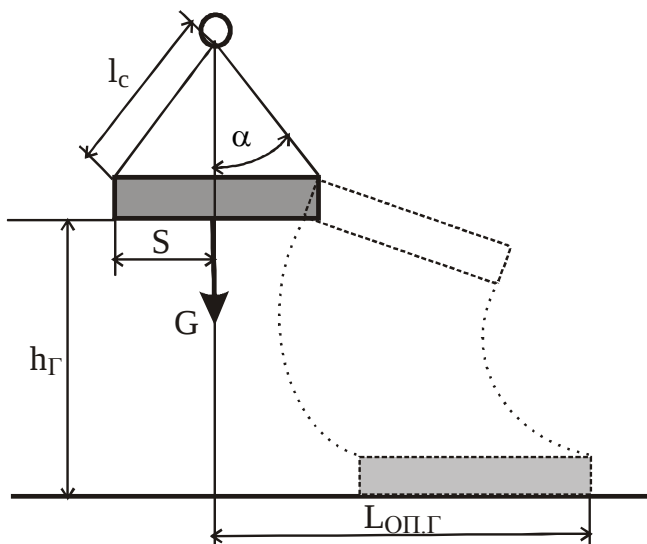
Схема определения границ опасной зоны при обрыве стропа грузоподъемной машины
